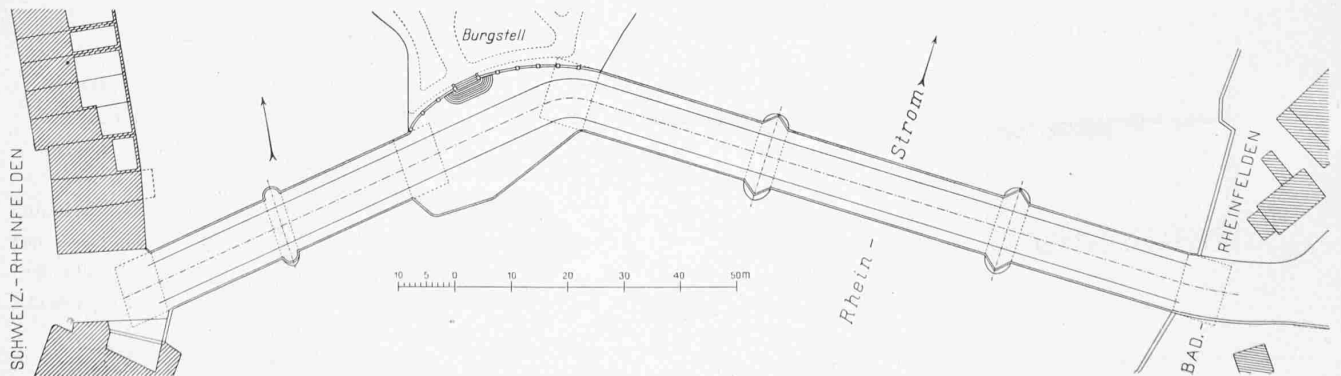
I. Preis. Projekt Nr. 19. — Lageplan der Brücke. — Masstab 1 : 1200.
